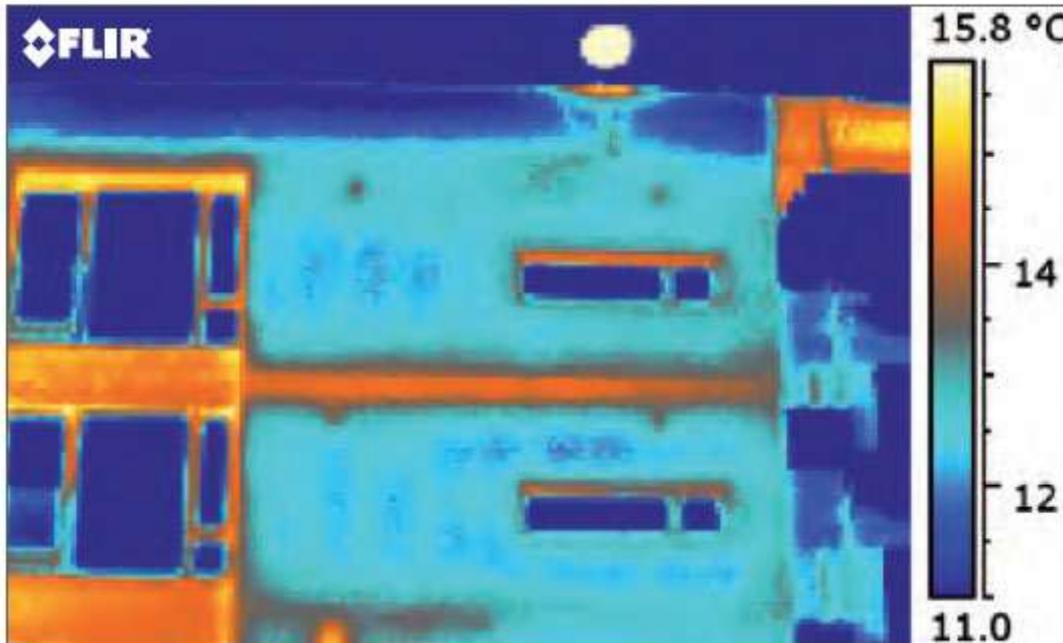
Pont thermique au plafond (FLIR Systems)
